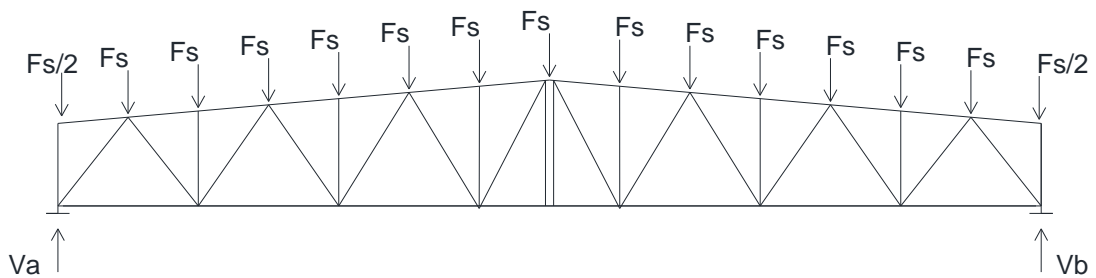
Схема приложения снеговой нагрузки на ферму
